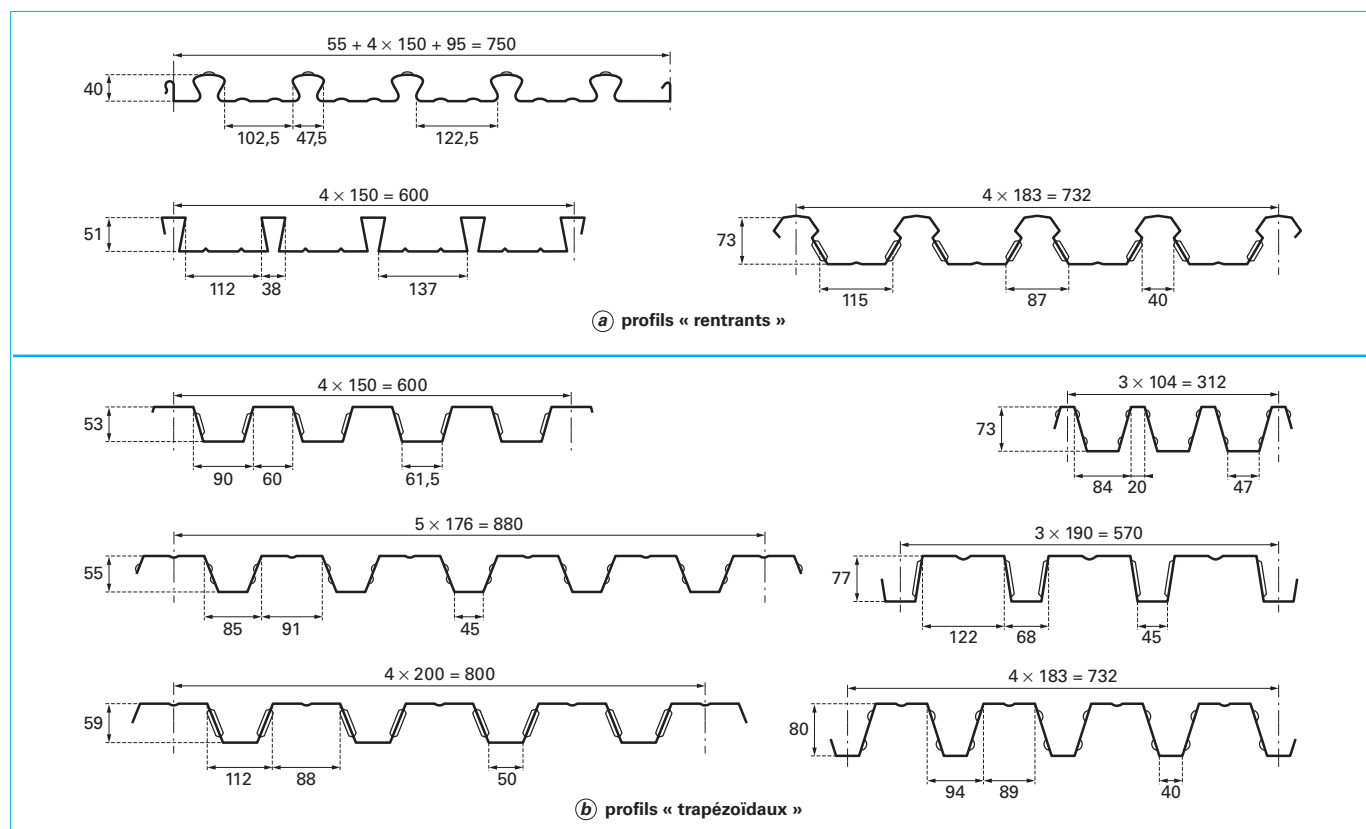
Exemples de tôles nervurées utilisées pour les dalles mixtes
